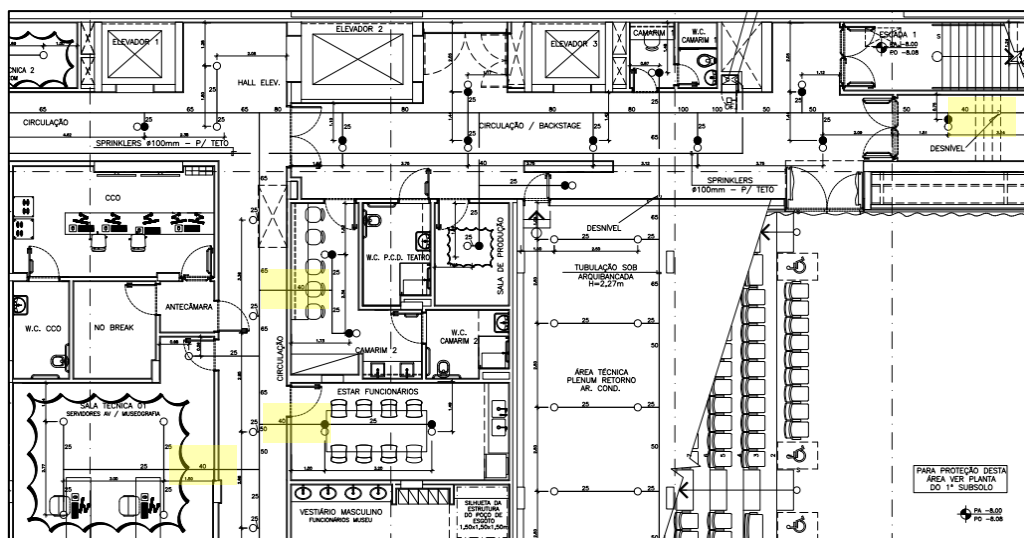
Demonstração da Patologia da Tubulação de aço galvanizado de 40 mm – 6º Pavimento
